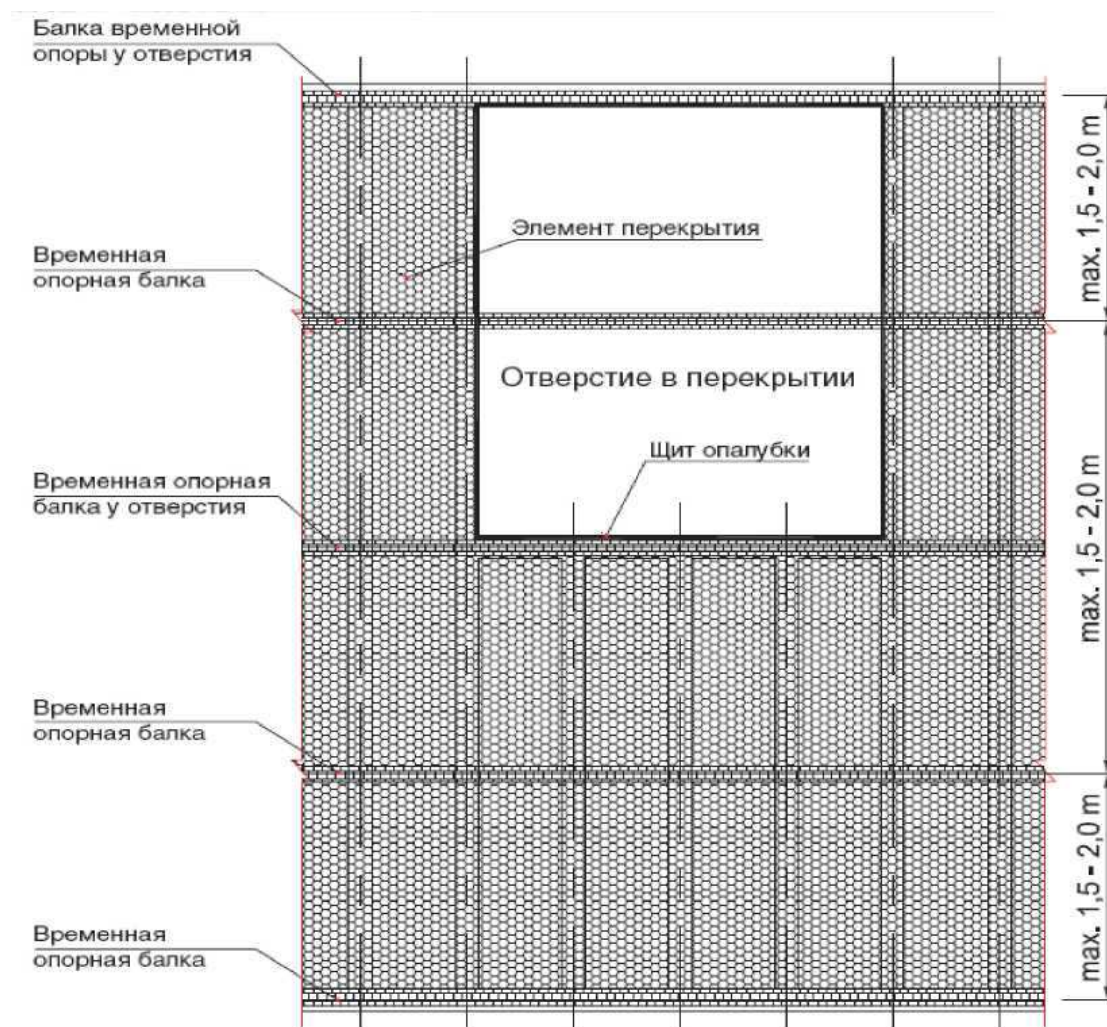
Опора элементов опалубки перекрытия у отверстия.
